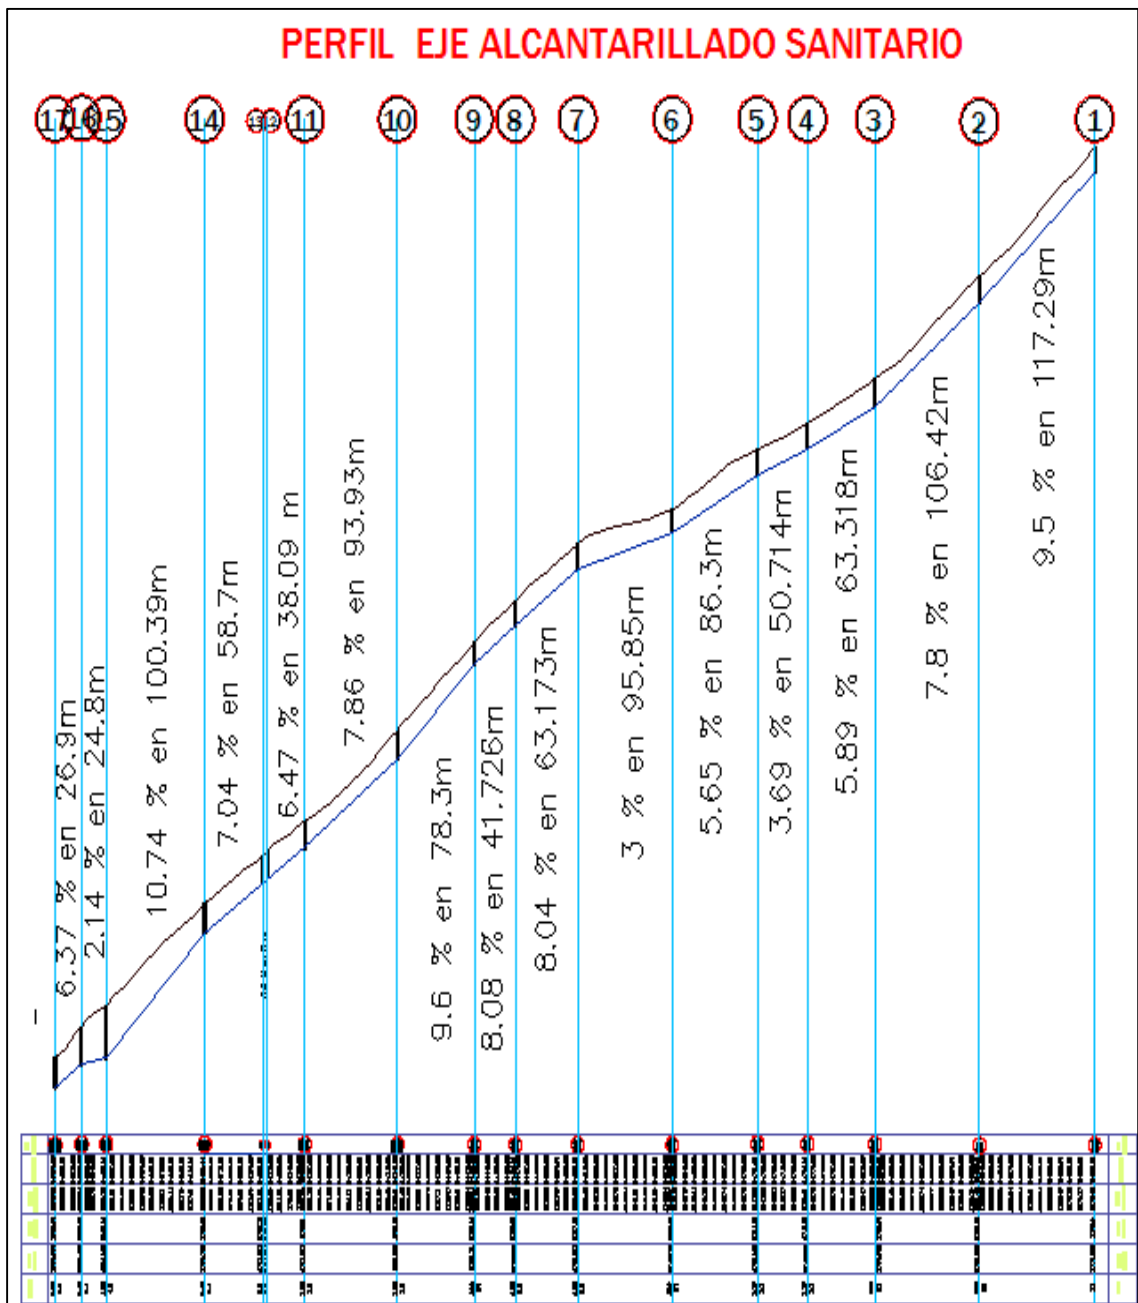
Perfiles diseño alcantarillado sanitario sector Jongovito centro
